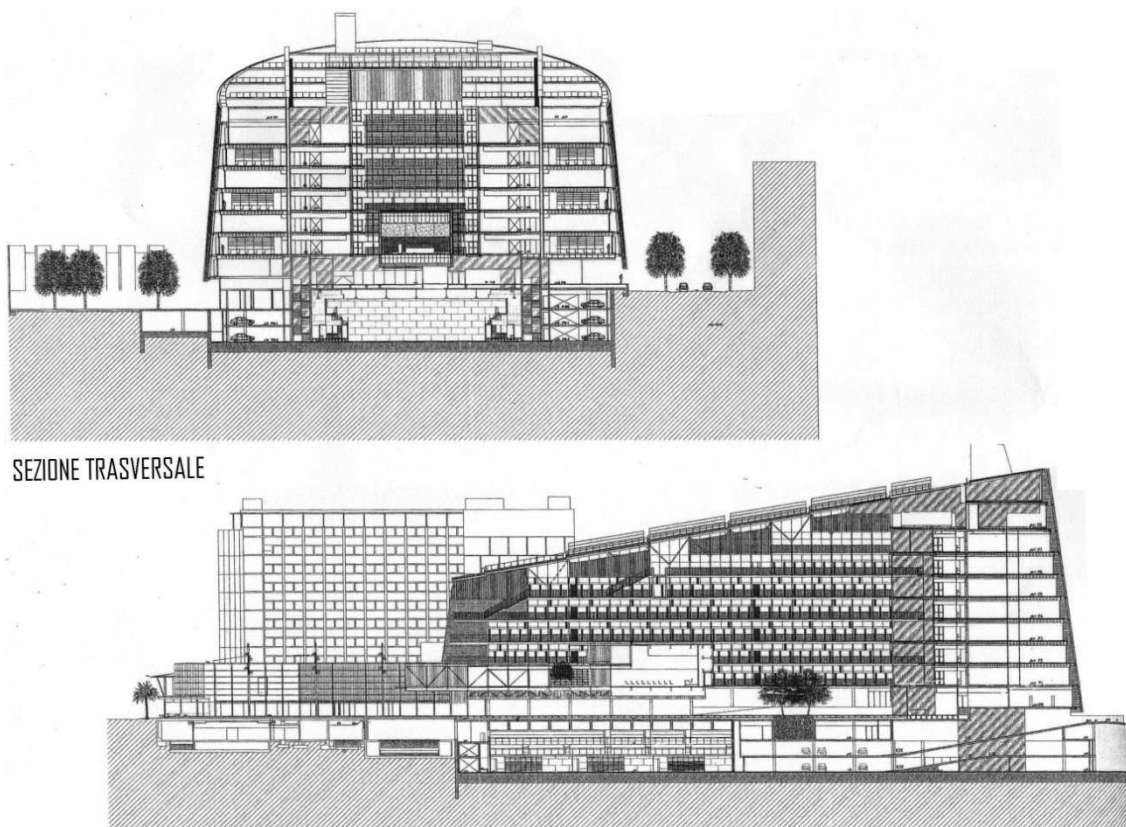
sezione trasversale e sezione longitudinale del centro PRBB.
